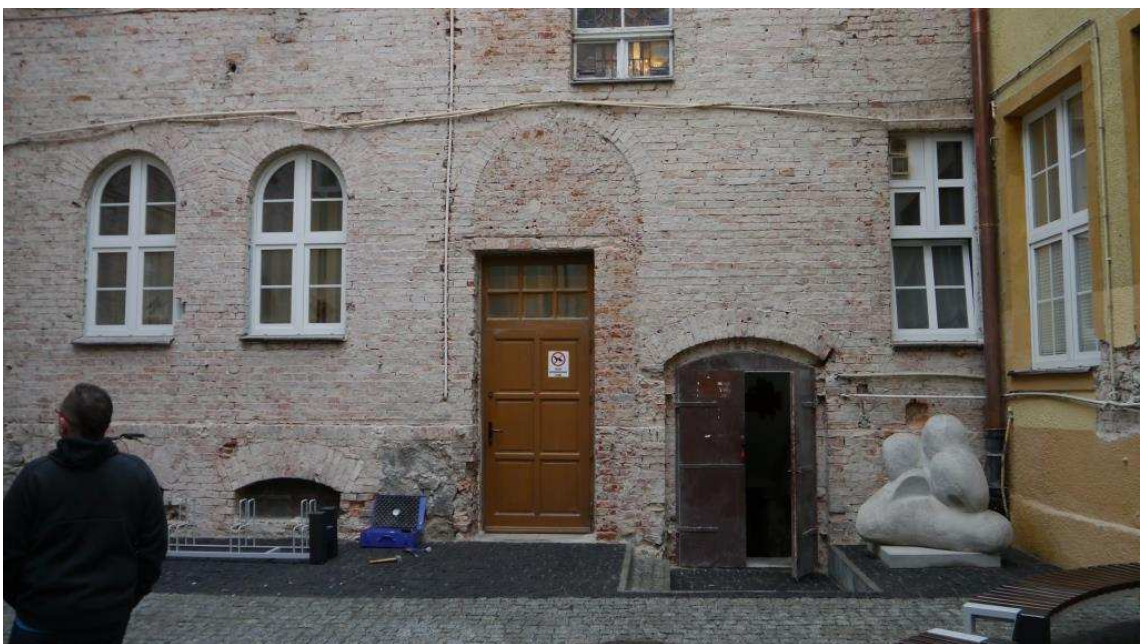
Przejście pod budynkiem – elewacja południowa
